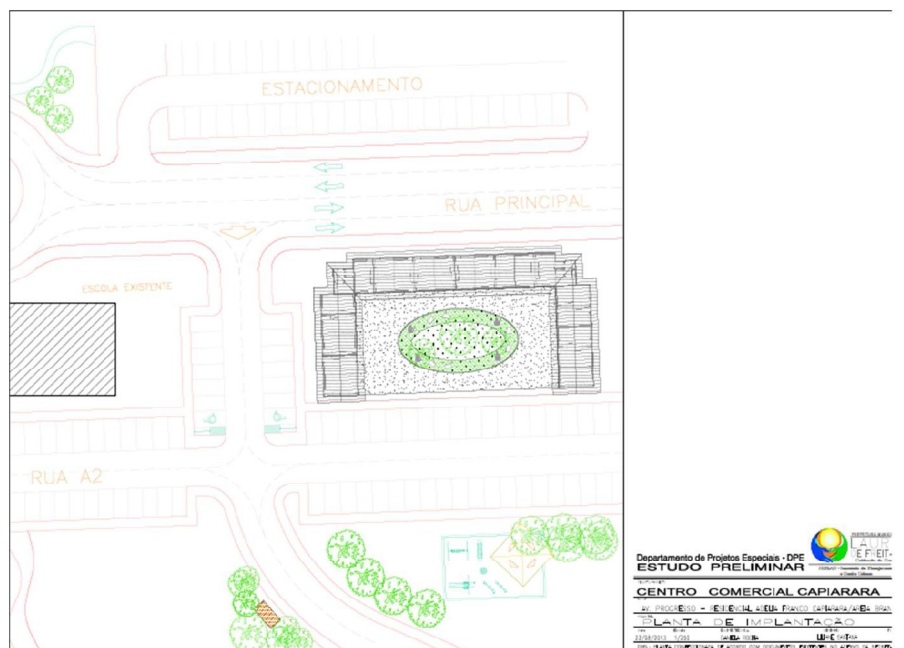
Planta de implantação do Centro Comercial Capiarara – opção 1.
